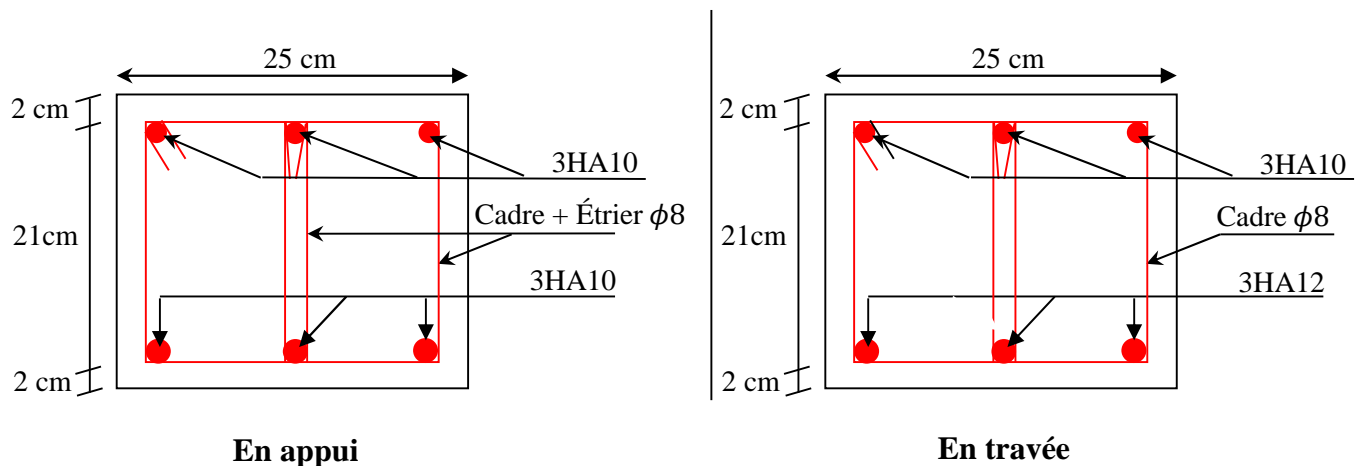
Schéma de ferrailage de la poutre de chaînage
